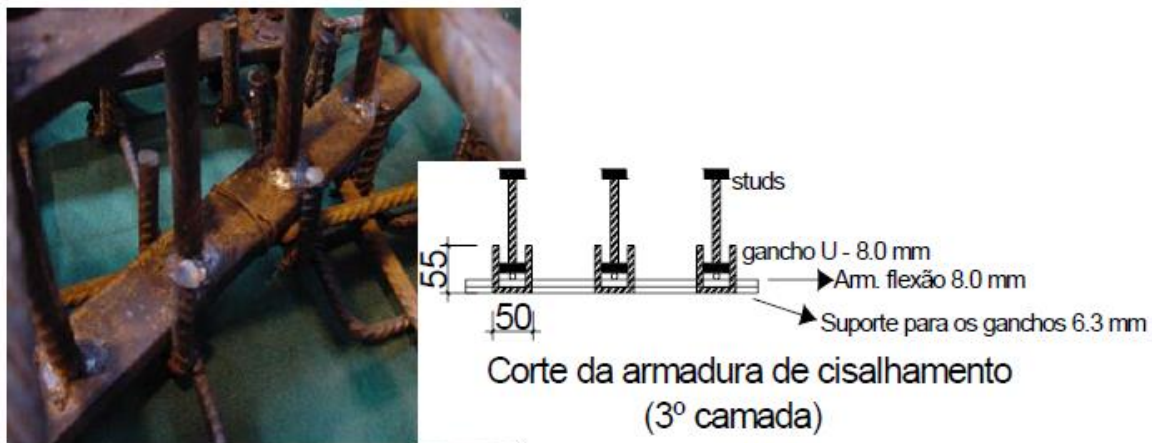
Detalhamento da armadura de punção das lajes E3, b4 e E5
